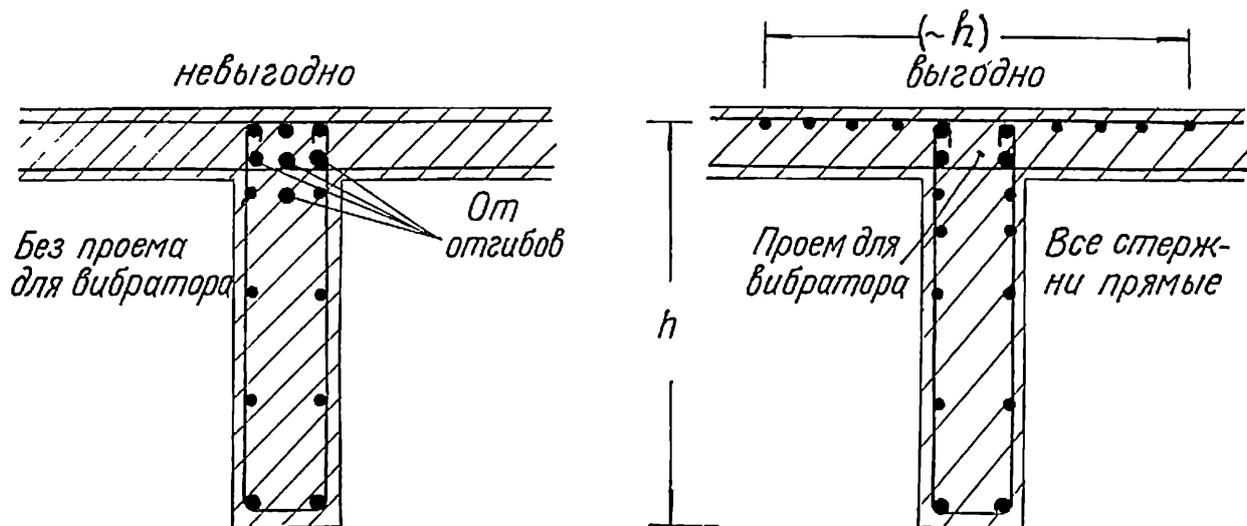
9. Установка верхней арматуры для восприятия моментов на опоре в ребристых перекрытиях
